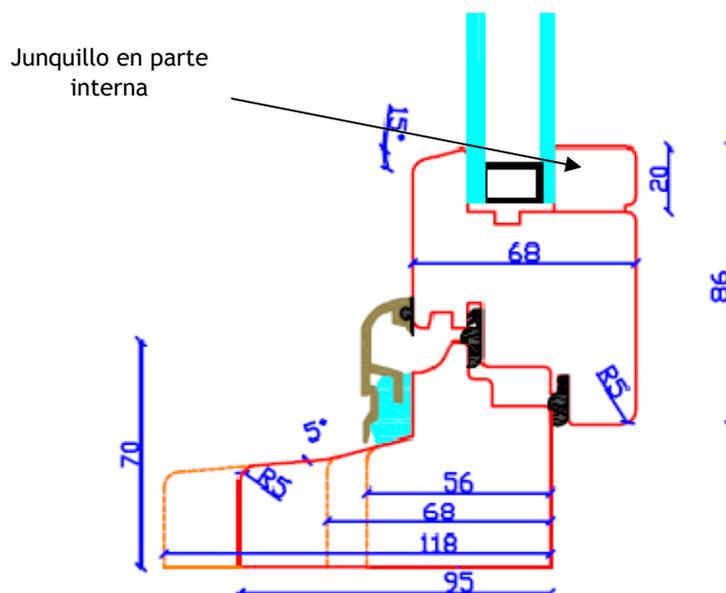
Sección longitudinal. Detalle del junquillo.
